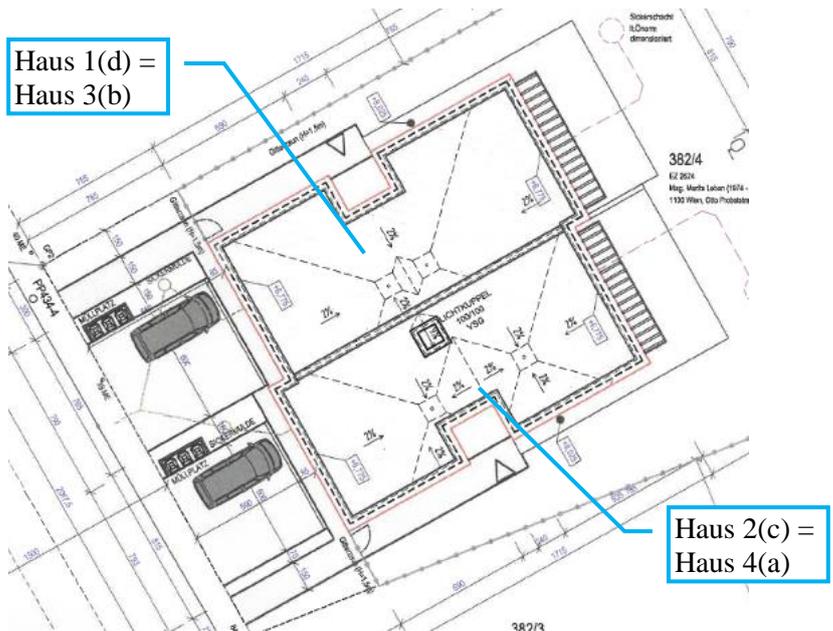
Ausschnitt Lageplan Einreichplan, mit Ergänzung Haus 1-4
